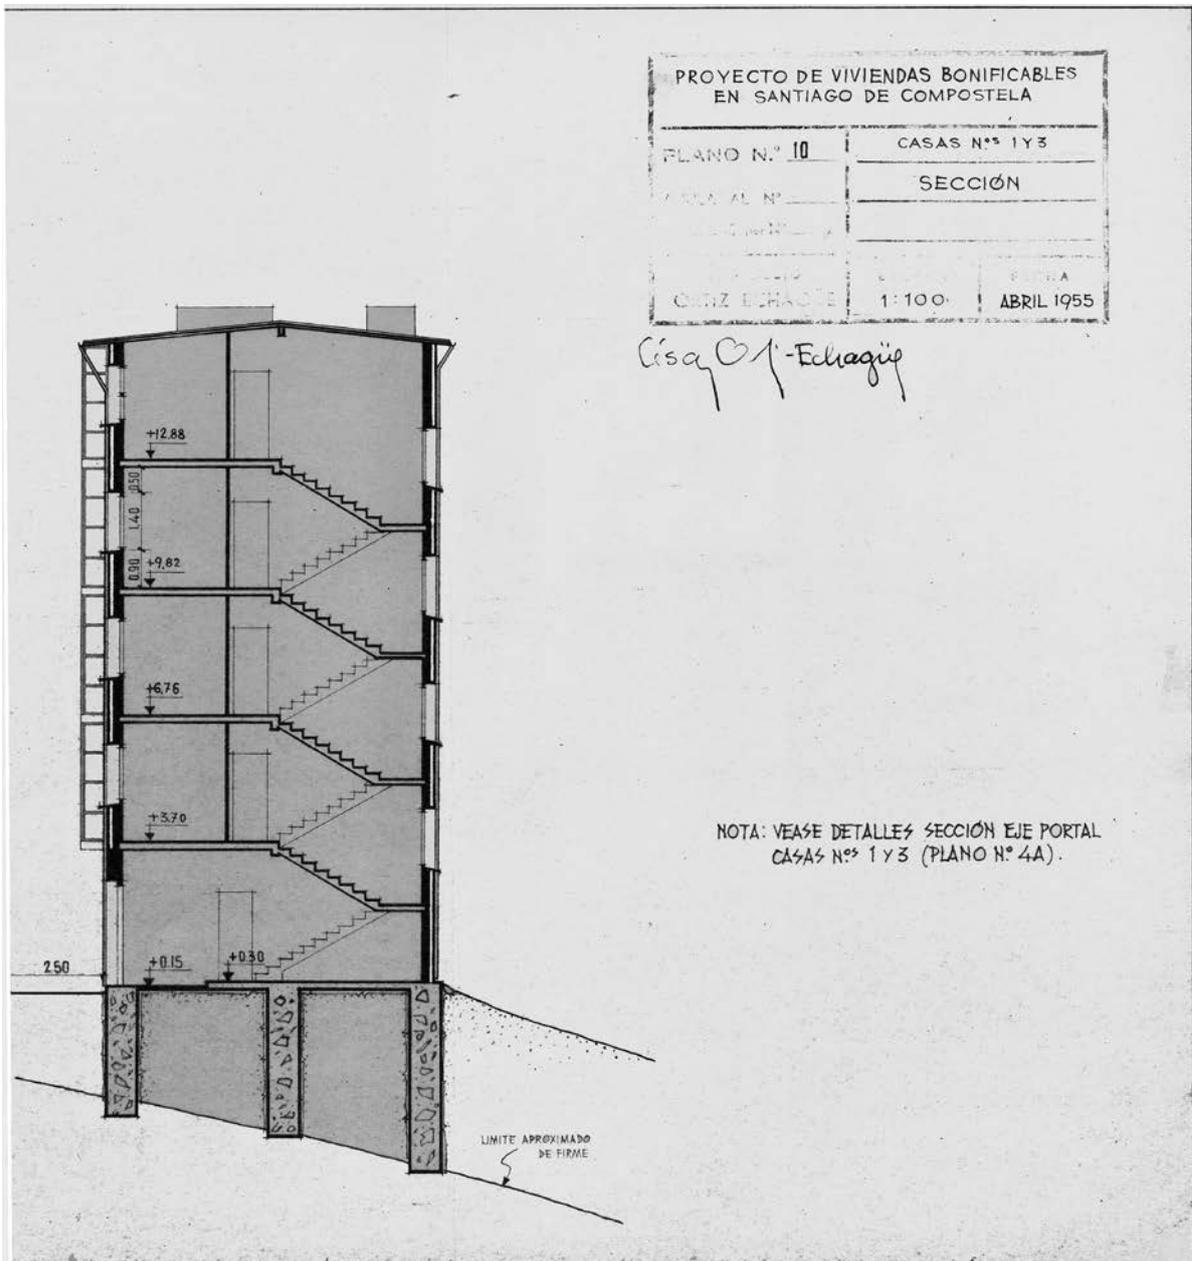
Plano N° 10, abril 1955. Sección vertical de las casas N° 1 y 3.
